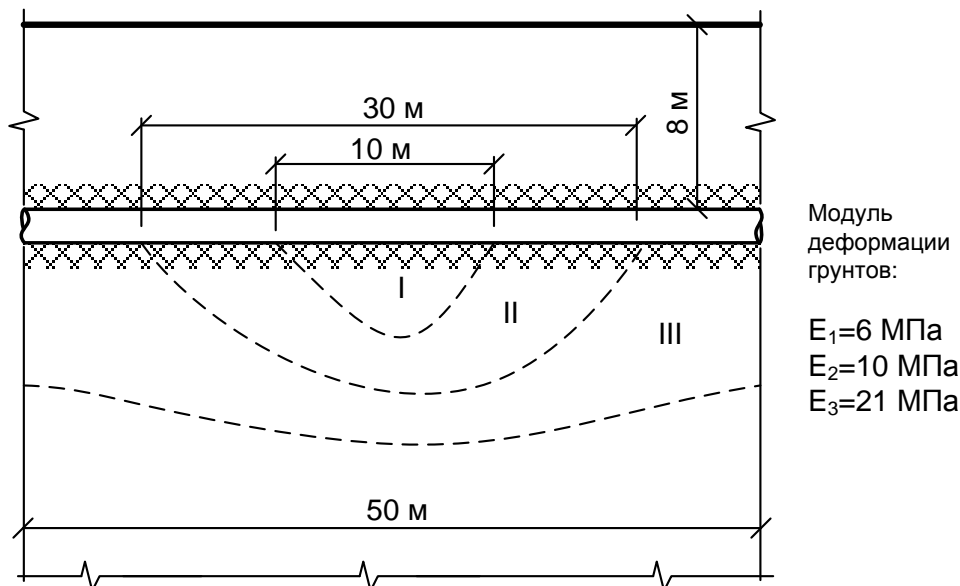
Схема укладки трубопровода на участке просадки
